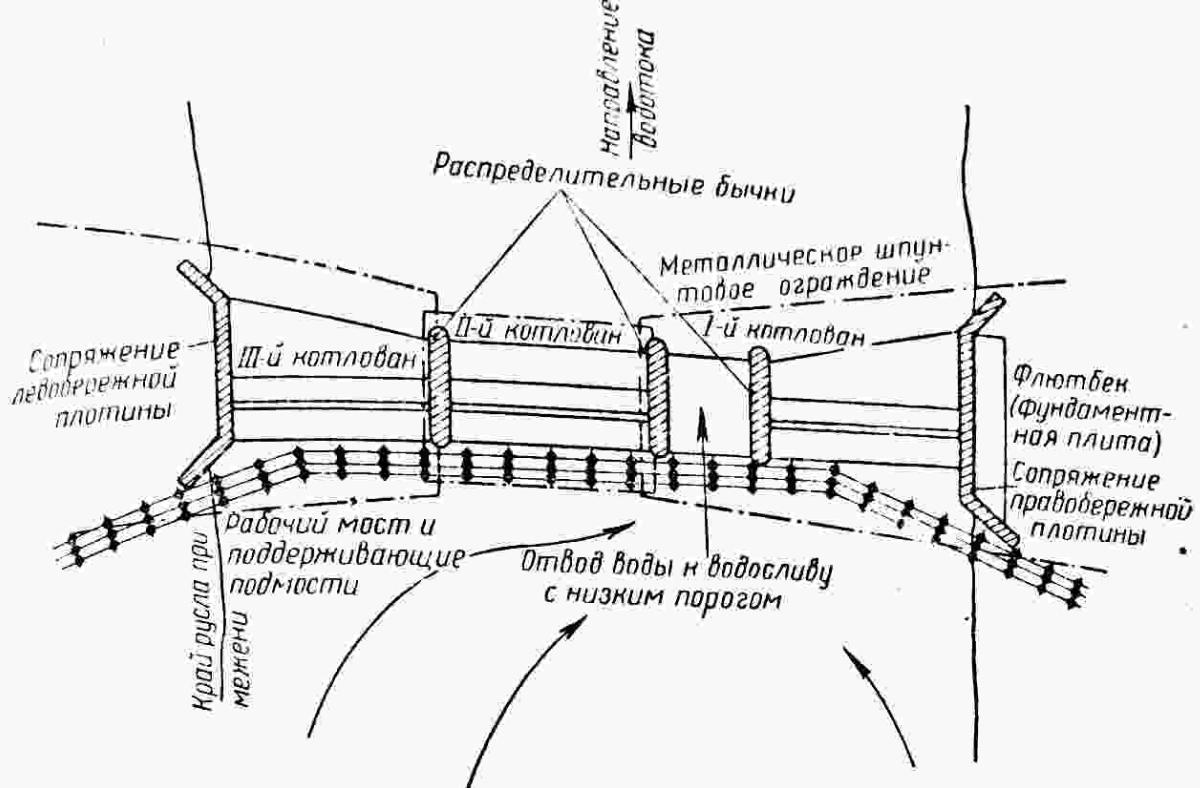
Последовательное ограждение котлованов водоподъемной плотины
